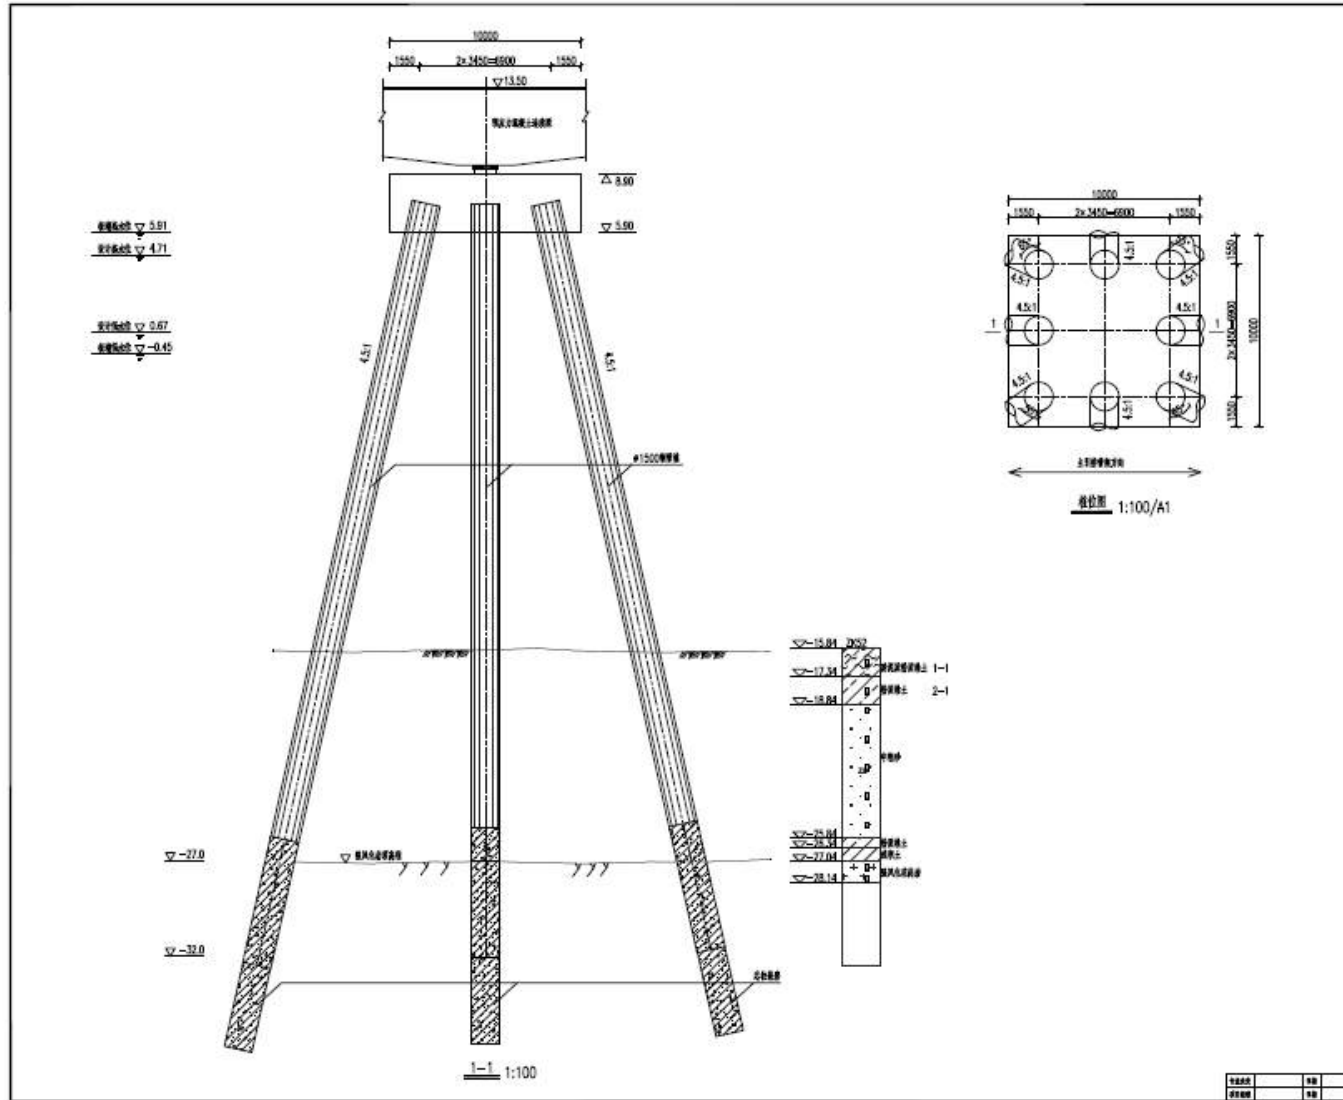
30 万 t 级码头引桥墩结构断面图
